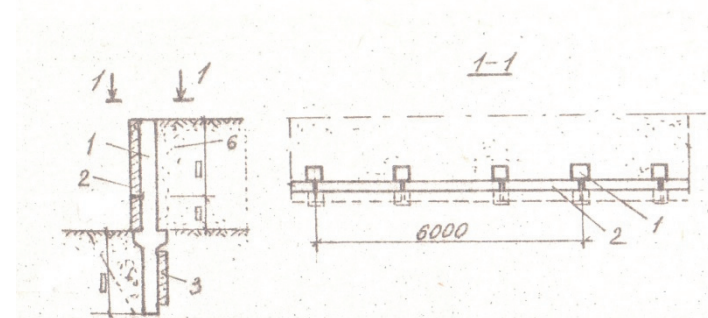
Свай-колоннны и плиты перекрытия в качестве подпорной стены:
